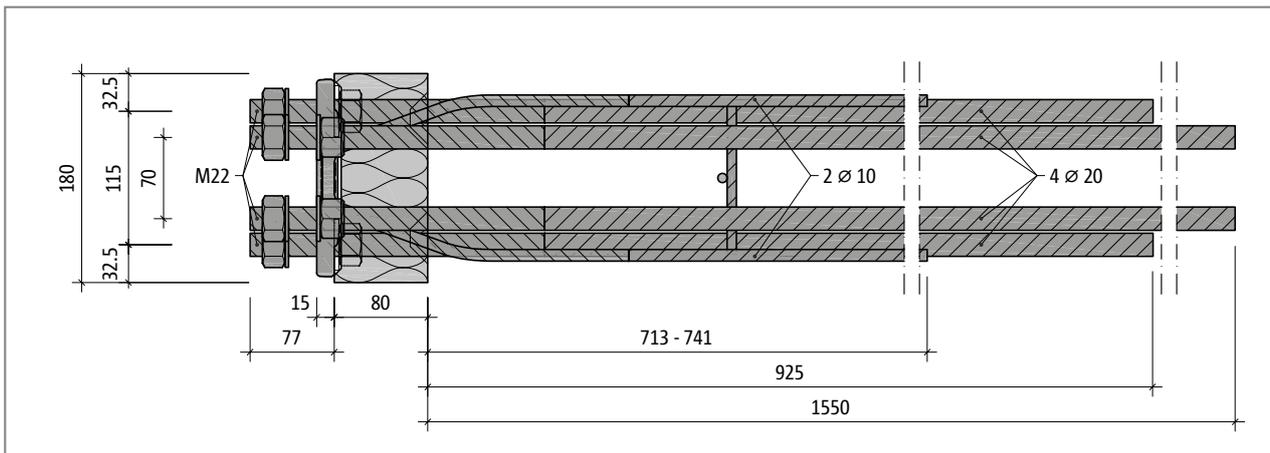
Schöck Isokorb® T type SK-MM2-VV1: Plan view
